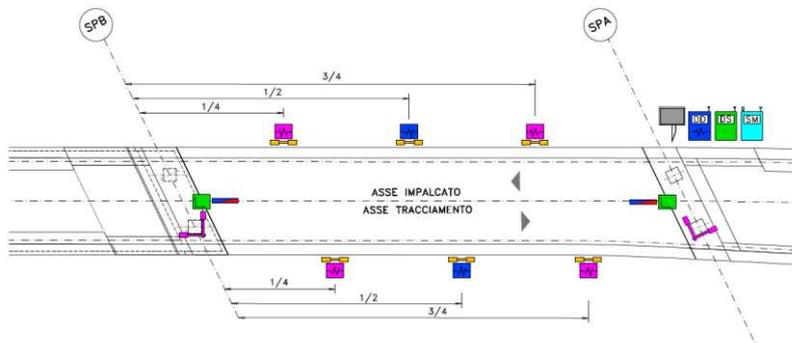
Schema soletta impalcato posizionamento strumentazione cavalcavia
